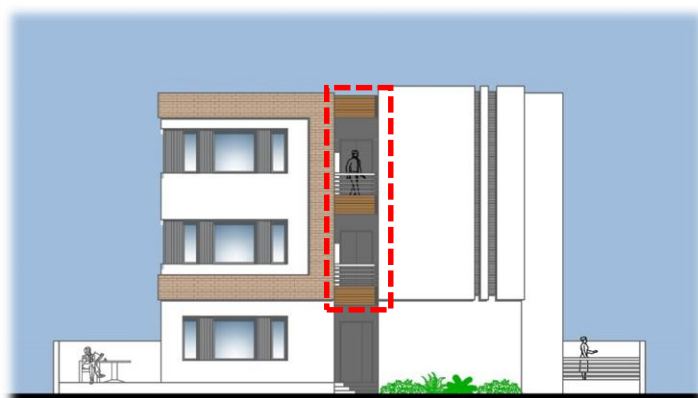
Esquisse B - Façade Ouest (avec terrasse)
